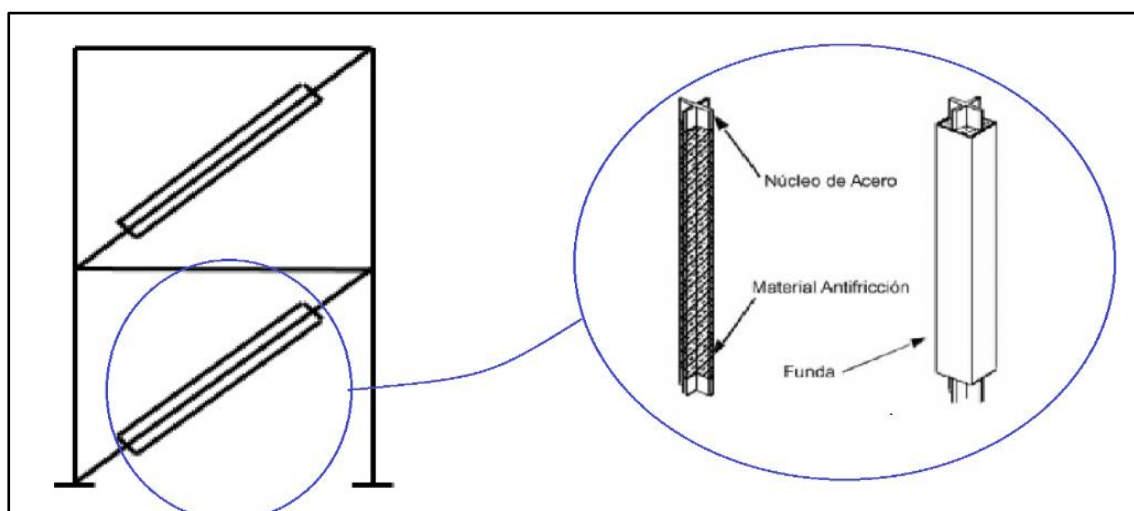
Tipo de pórtico arriostrado con pandeo. Aguirre (2016)
